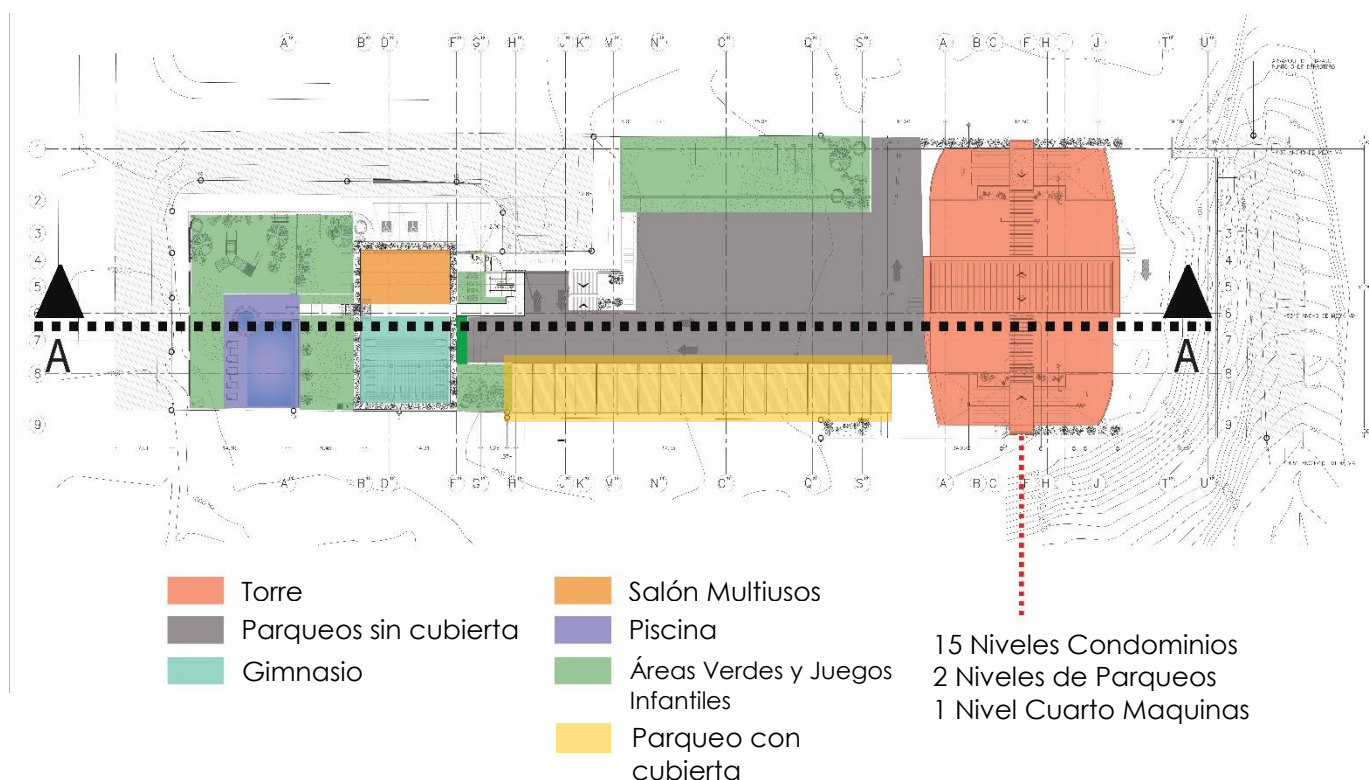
Diagrama Planta de Conjunto Condominio Vistas del Robledal. Fuente: Elaboración propia
